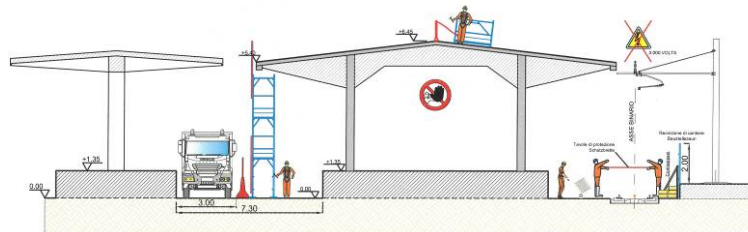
Sezione Demolizione Edificio A9 – Ponteggio/scala – Linea vita – Protezione binario – Recinzione marciapiede
